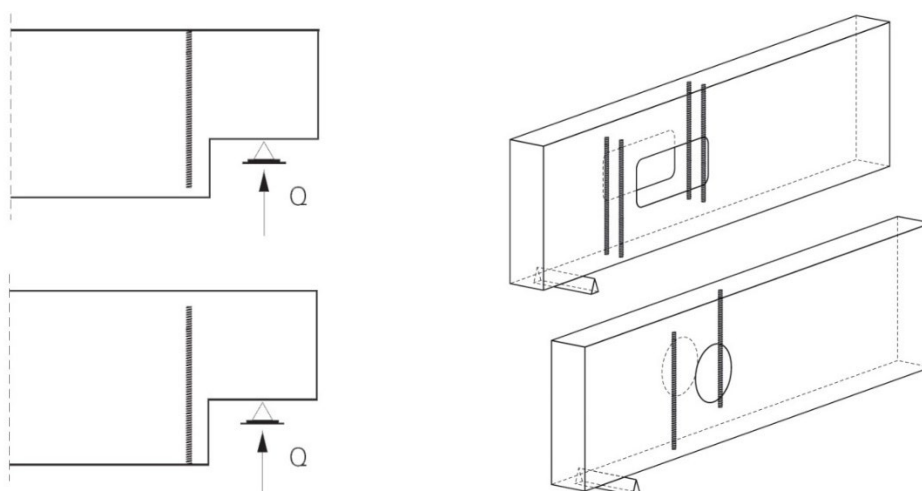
Verstärkung von Ausklinkungen (links) und Durchbrüchen (rechts) mit Vollgewindeschrauben oder eingedrehten Gewindestangen, (Allchemet AG)
